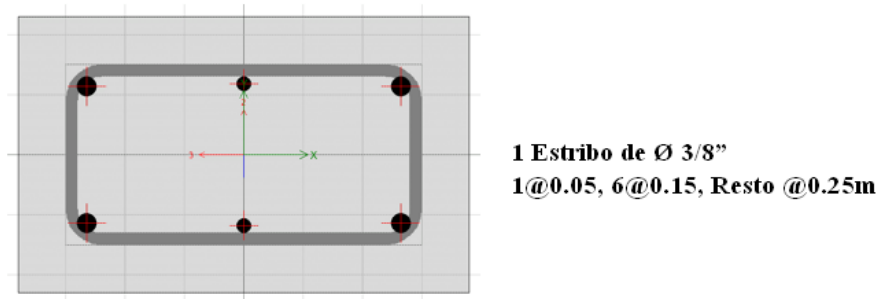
Distribución de estribos de refuerzo en la columna C1.
